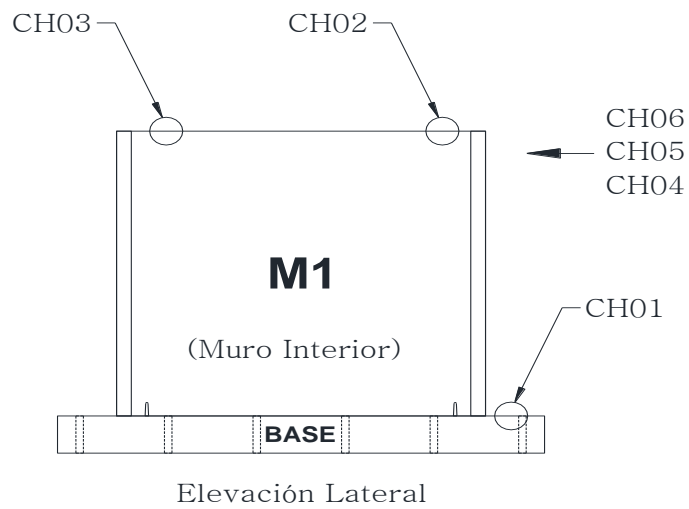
Ubicación de los sensores en el muro para medir desplazamiento.
